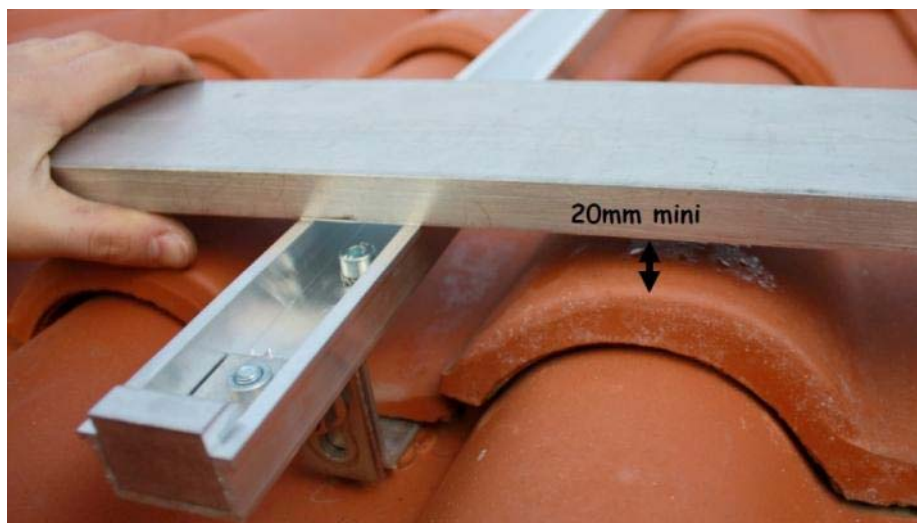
Exemple de montage du kit de fixation pour 1 capteur horizontal sur toiture en tuiles à fort galbe
